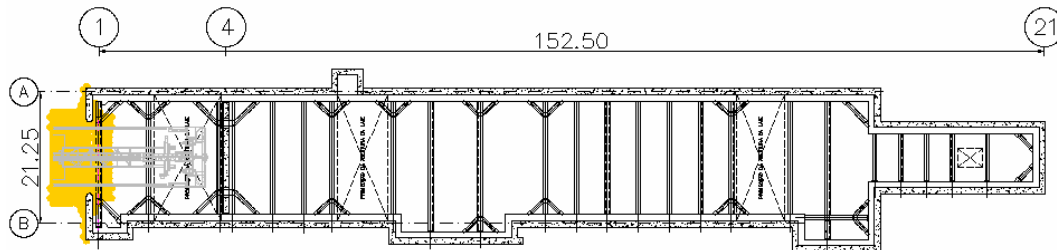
Planta da Estação. Paredes moldadas com escoramentos
